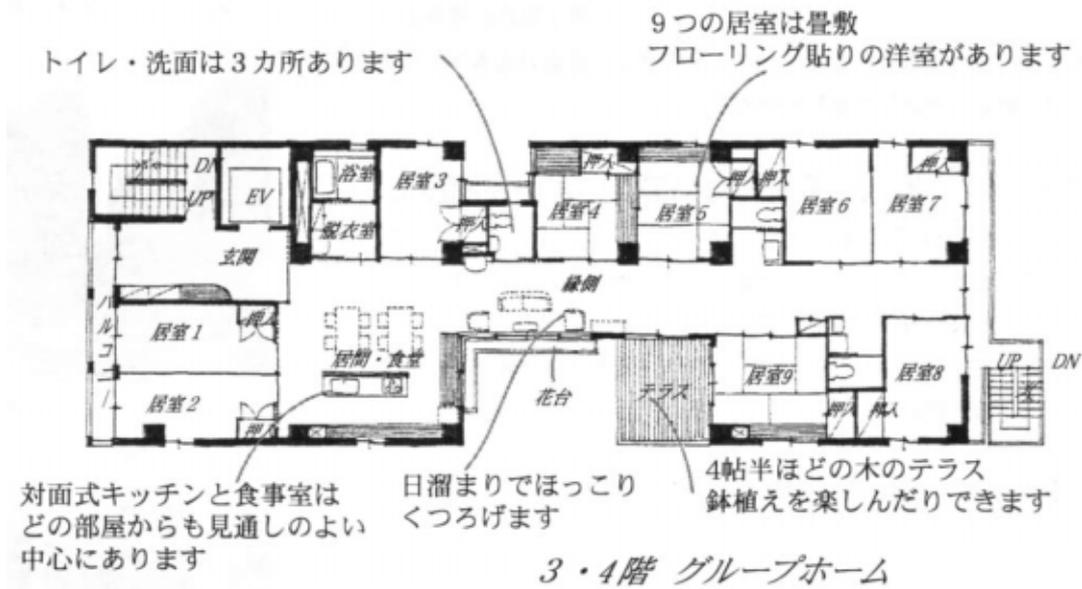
中心市街地の居住福祉施設（京都市中京区）グループホーム平面図
